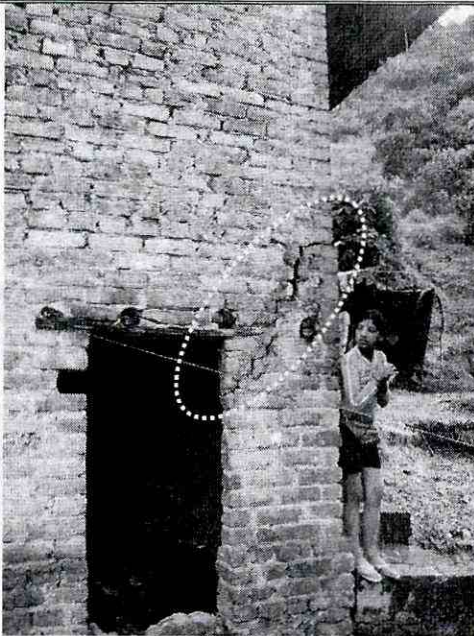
Agrietamientos en mampostería de la vivienda de la Finca Los León, la cual presenta aberturas del orden de los 2 y 4cm
